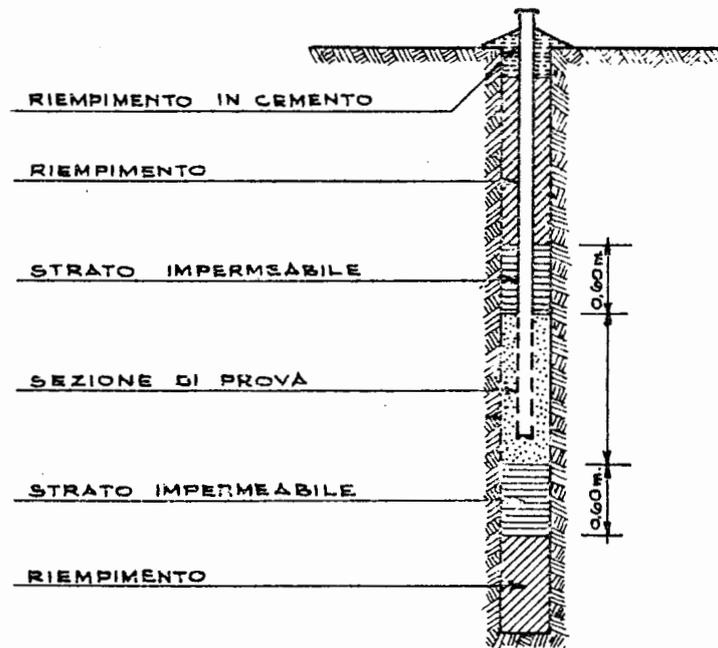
SCHEMA DI UN PIEZOMETRO A TUBO APERTO (da T.H. HANNA)
